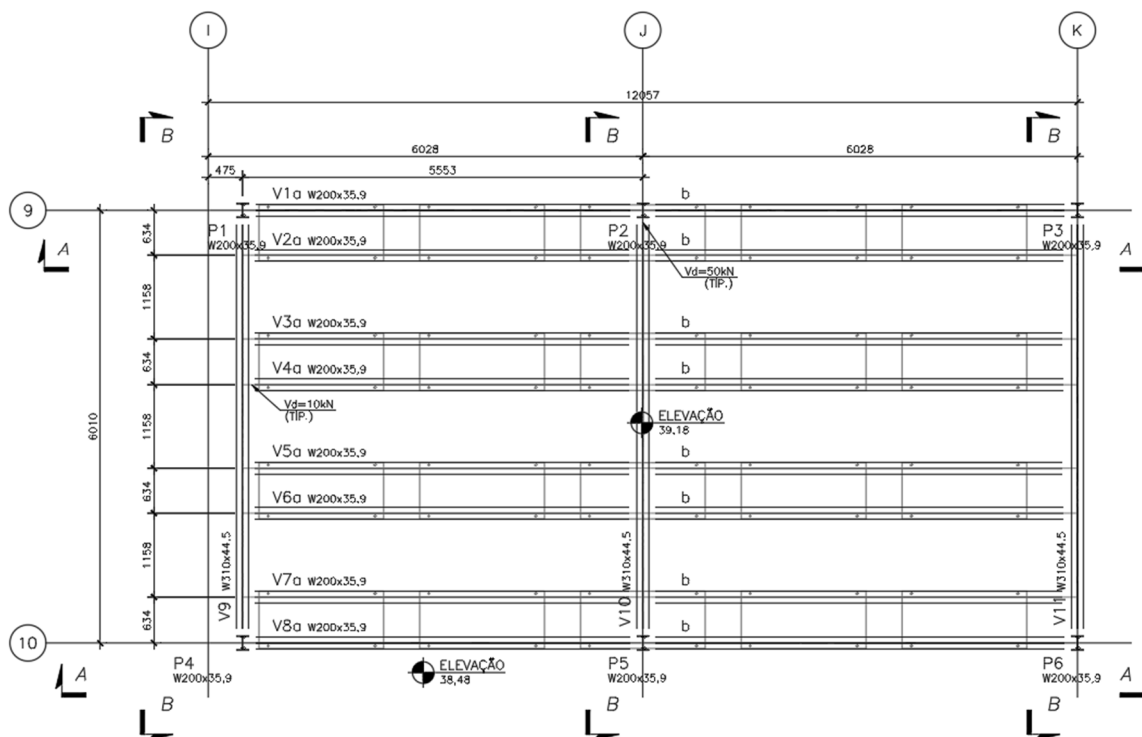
Planta do pórtico a ser instalado sobre a região à direita da edificação.
